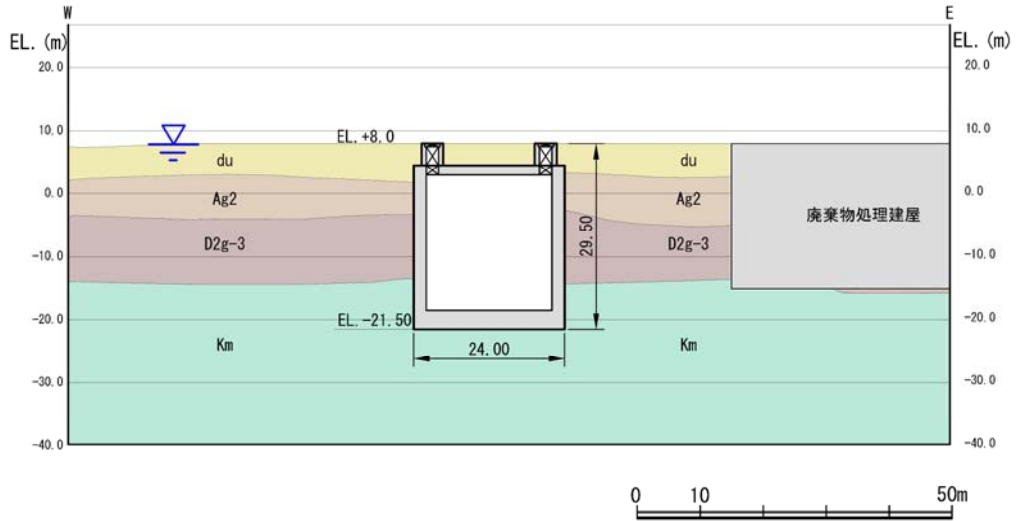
(3) 代替淡水貯槽地質断面图 (A-A 断面)
